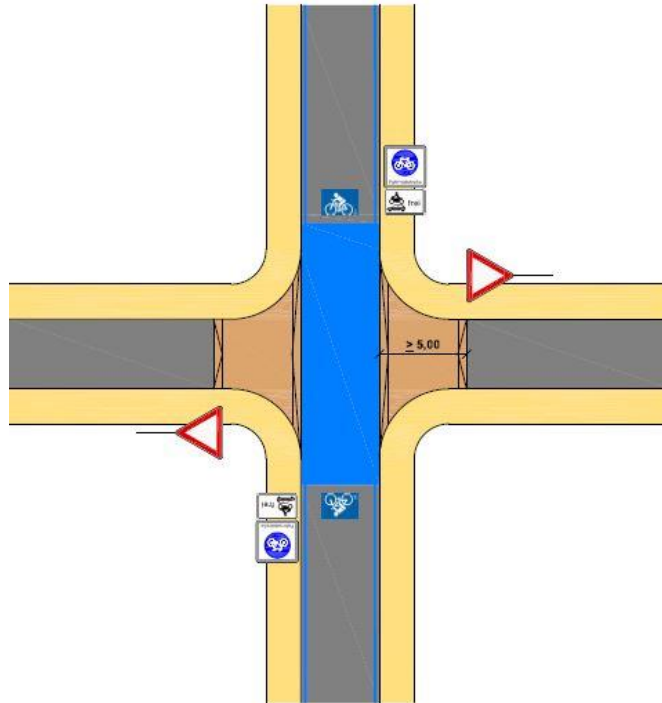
Prinzipskizze für die Bevorrechtigung einer Fahrradstraße im Erschließungsstraßennetz mit Gehwegüberfahrt im Zuge einer Premiumroute
